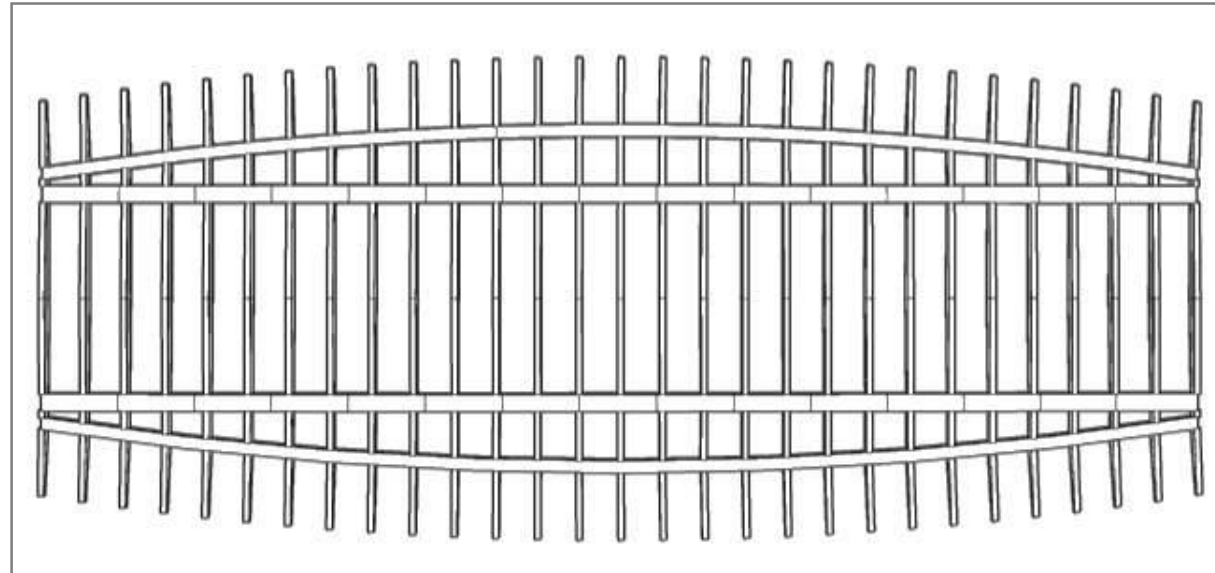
Vista en planta de vigas longitudinales y transversales (de piso)
